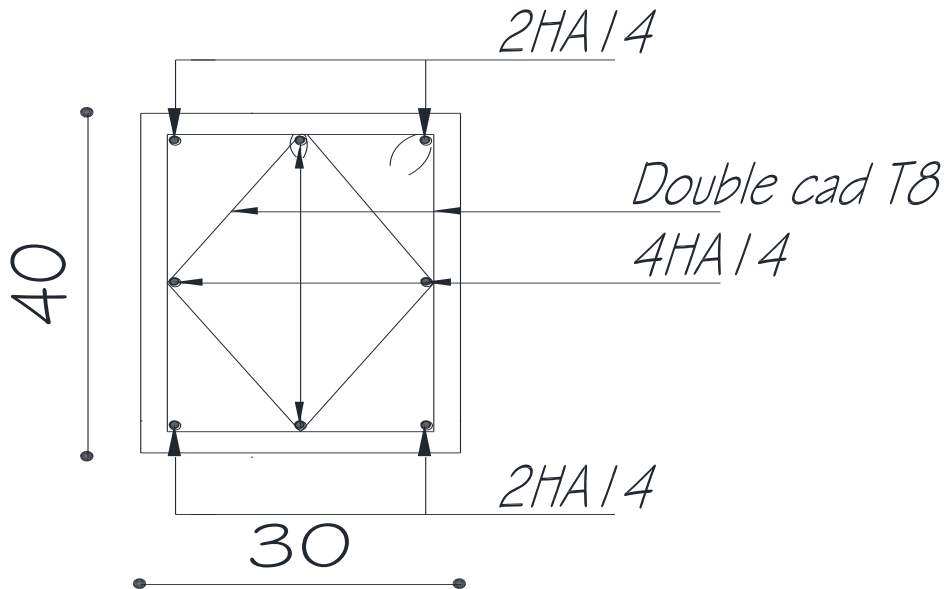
Schéma de ferrailage de poteaux section (30×40) cm²
